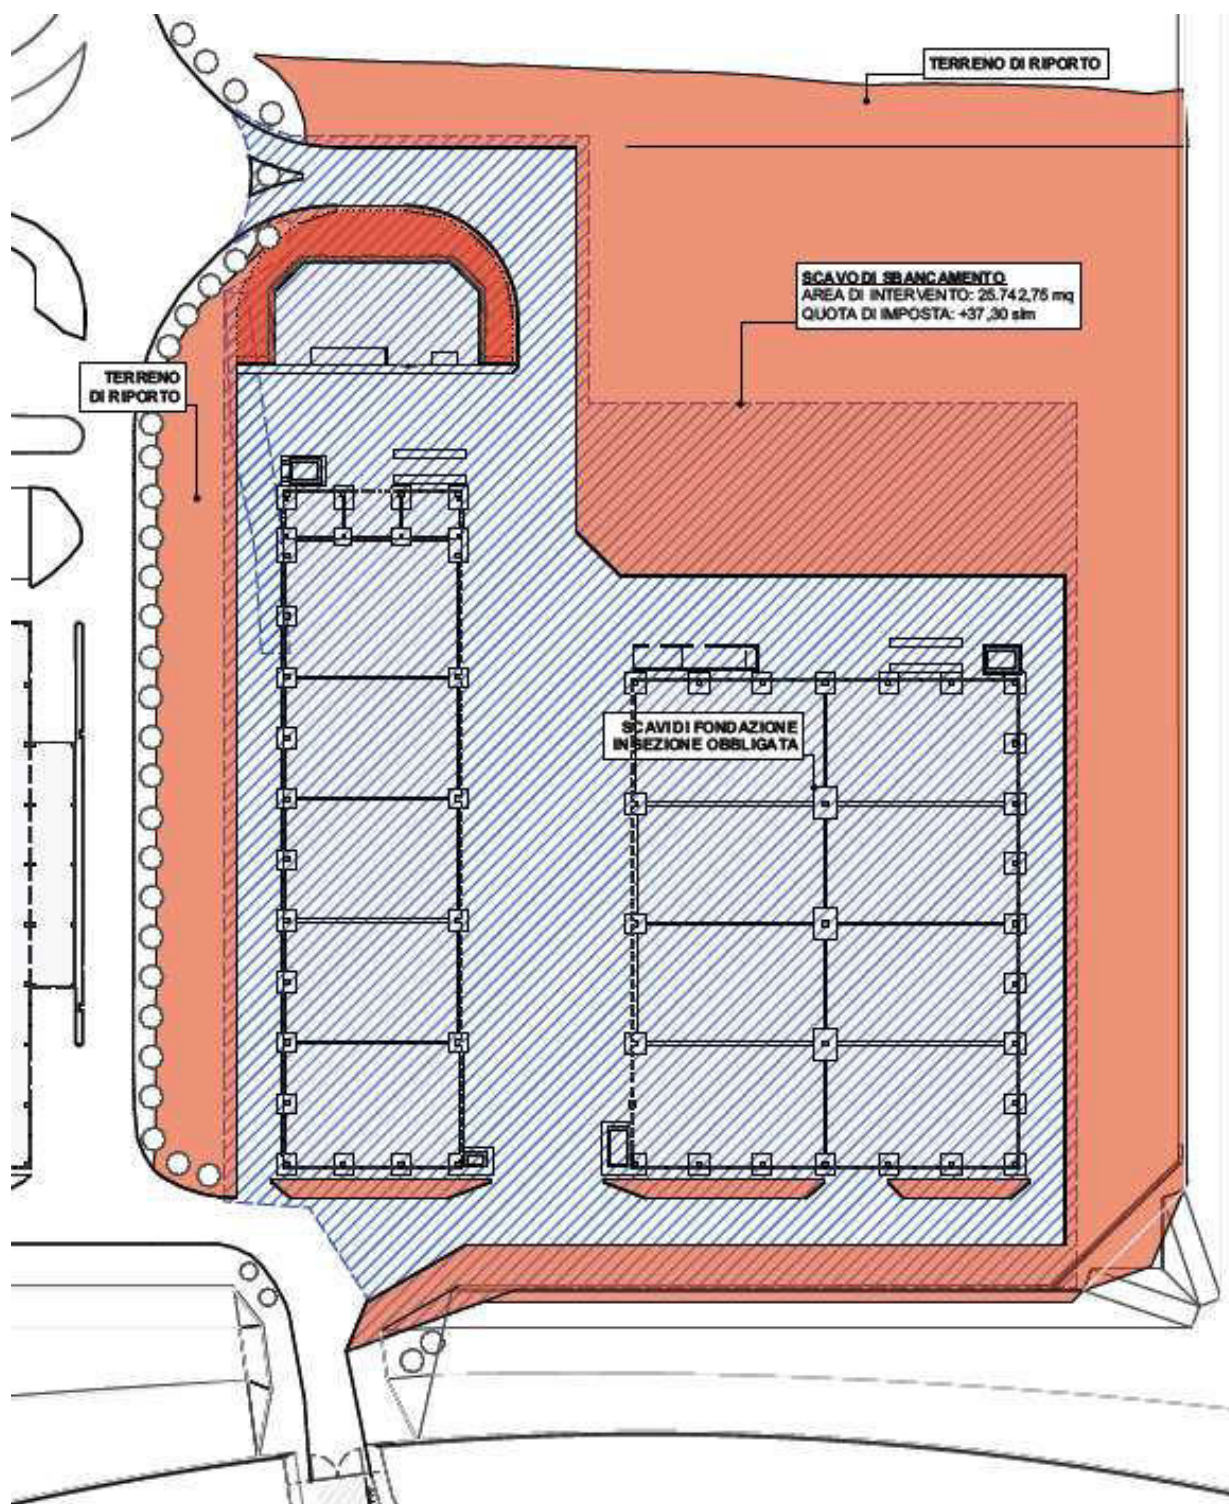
Planimetria Scavi e riporti di terreno. Sono previsti scavi di sbancamento fino a quota +37.30 m (retino azzurro), riporti di terreno (in arancio), e, in corrispondenza dei plinti di fondazione dei fabbricati A e B, scavi a sezione obbligata
